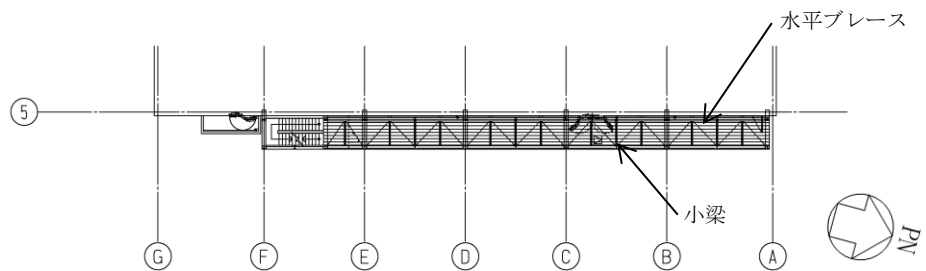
(3) 免震重要棟鋼製バルコニーの3階平面図
